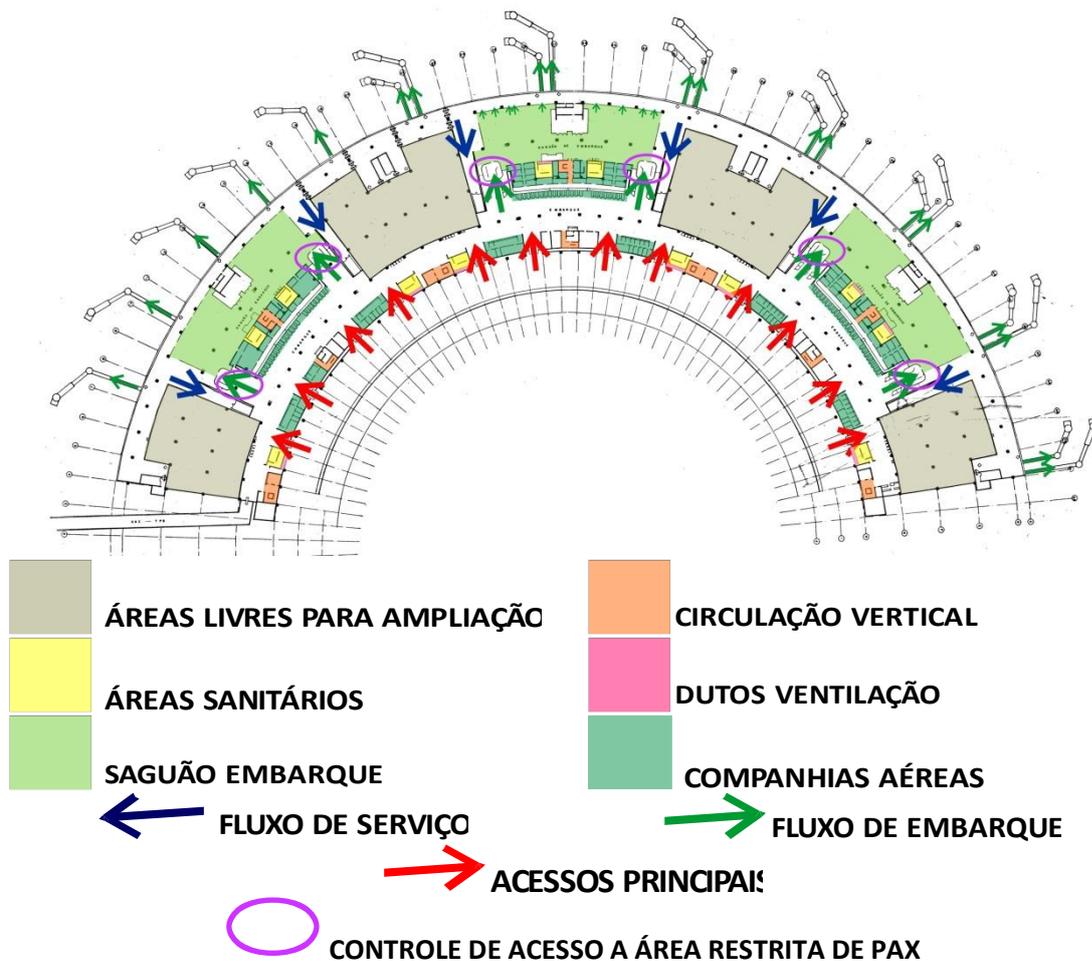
Pavimento Embarque em 1984 aproximadamente.
